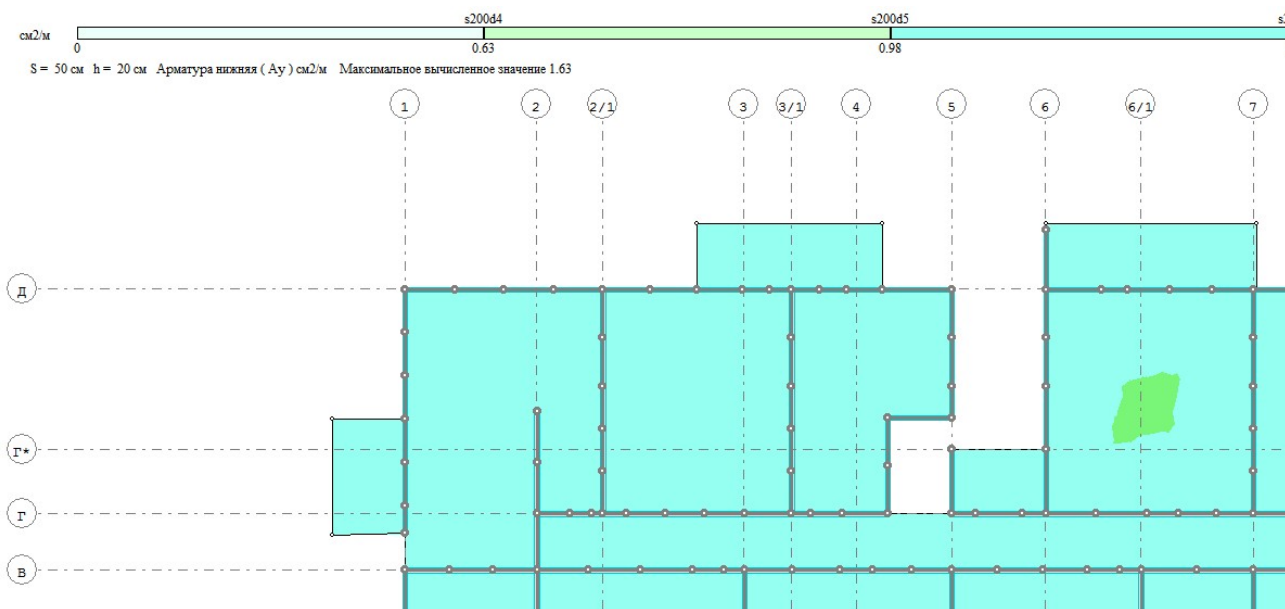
Нижняя зона армирование по оси Y(см<sup>2</sup>/п.м.).
